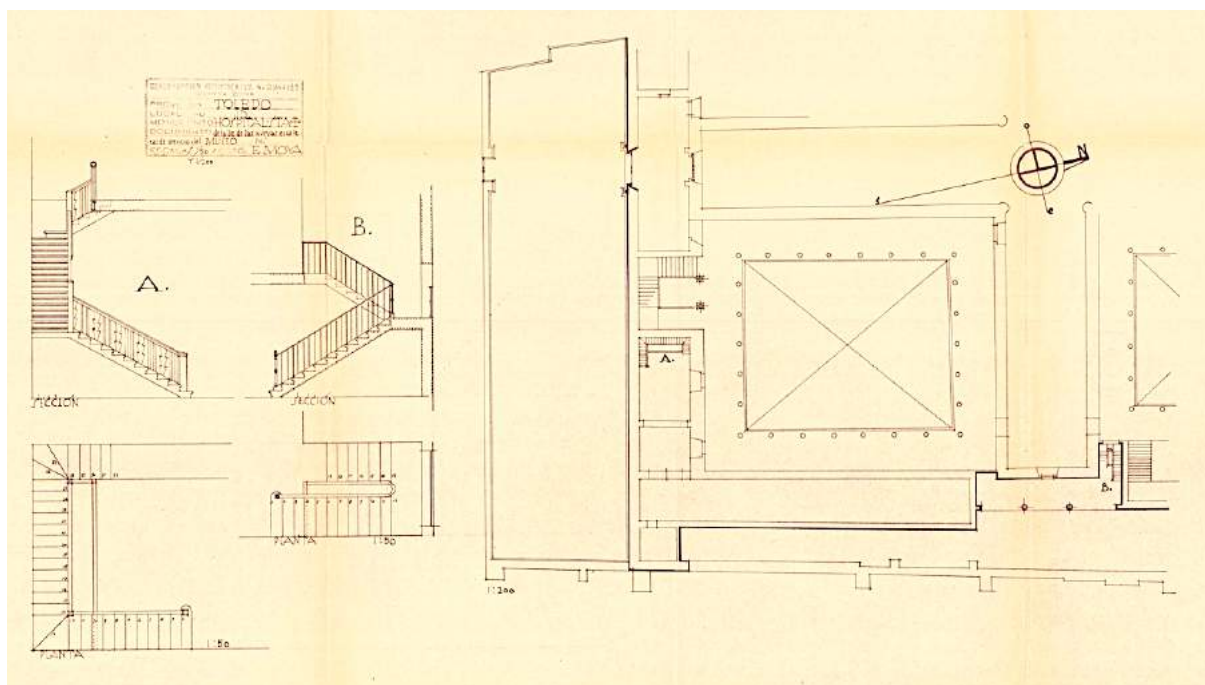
Plano de planta y sección de las escaleras que se proyectan, 1933. Fuente: A.G.A. Caja 31/04894 008
